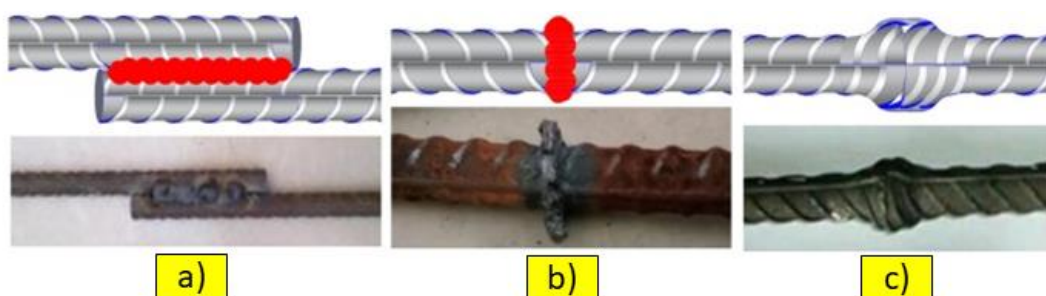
3 : Raccordement des barres par soudage : (a) suivant l'axe des barres, (b) bout à bout (soudure en bout) et (c) par forgeage (GPW)[31].
